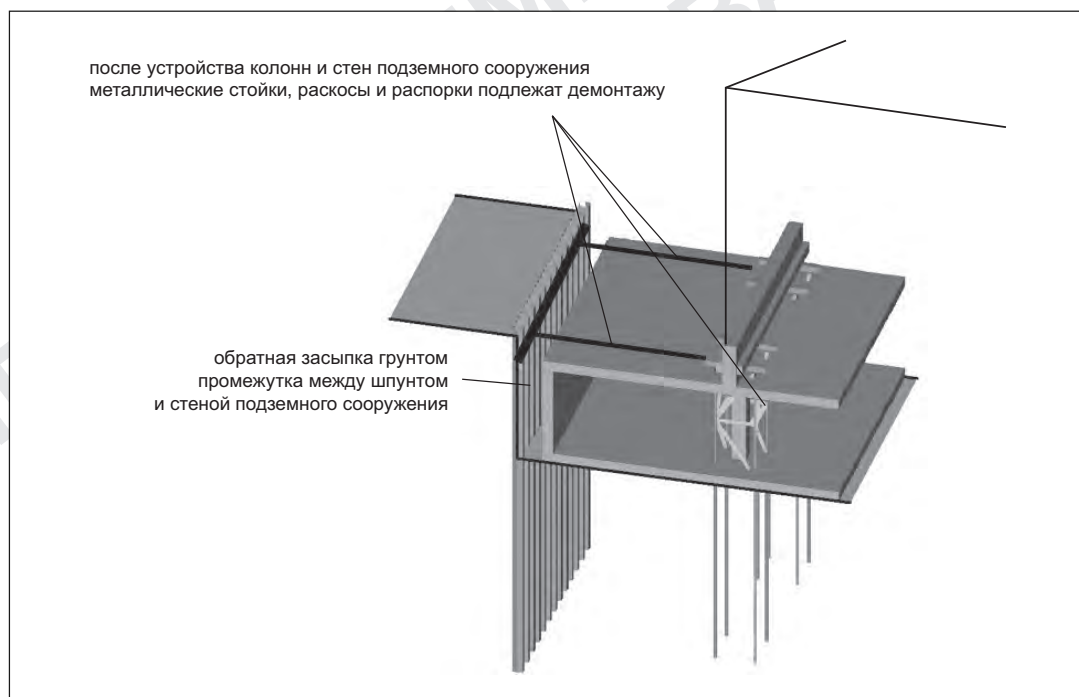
Бетонирование стен и колонн подземного сооружения
